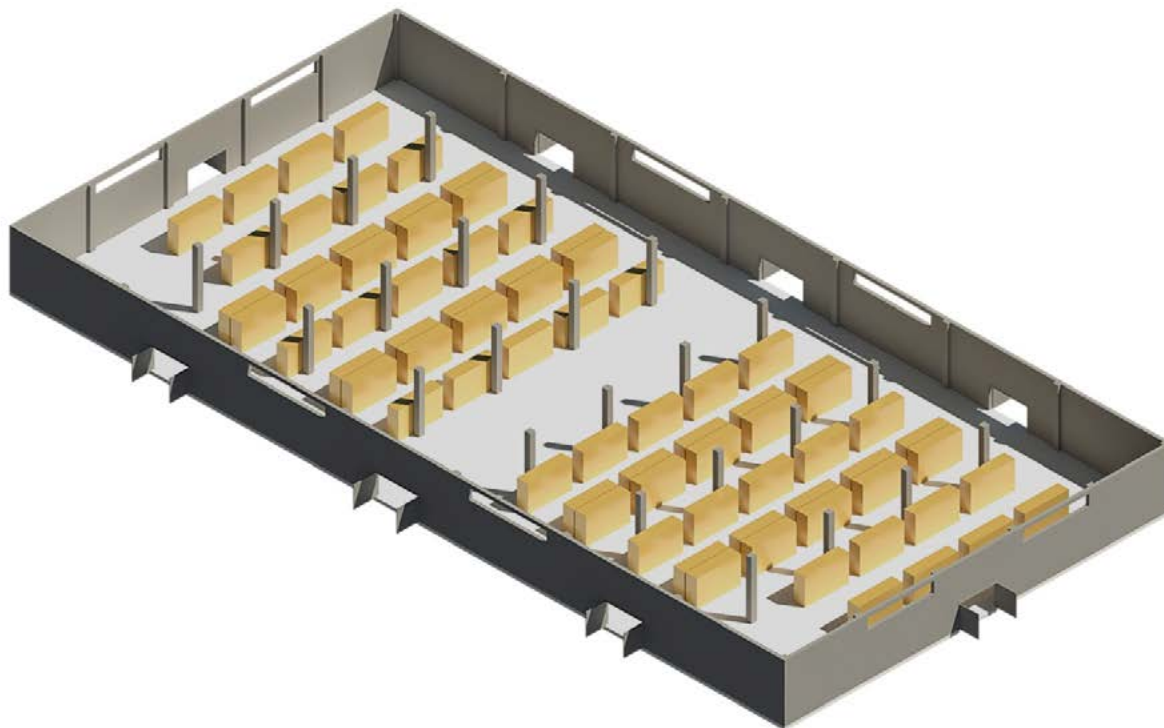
| Vista 3D assometrica, disposizione dei pilastri e della scaffalatura
